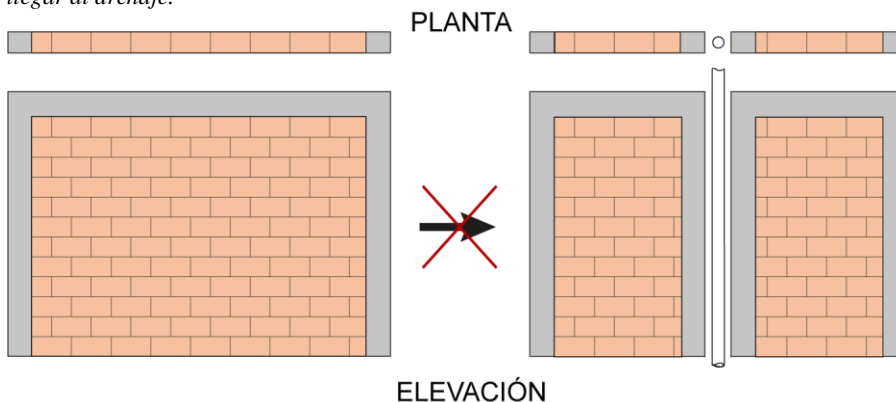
c – División de muros en obra para colocar tubería, no considerada en el proyecto estructural. Los ductos pueden adosarse al muro colocándoles un recubrimiento, por ejemplo, en cocinas, o bien para ductos de drenaje de aguas pluviales o residuales (fig. 10.2.4.6.5).
